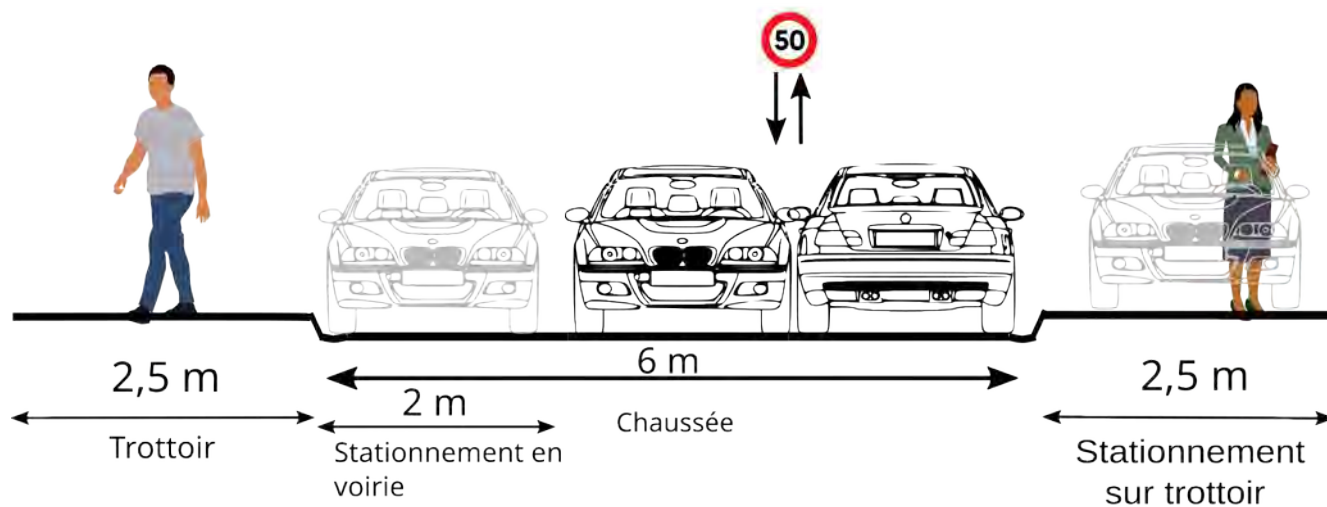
Coupe B-B' – Rue de Montegnée
